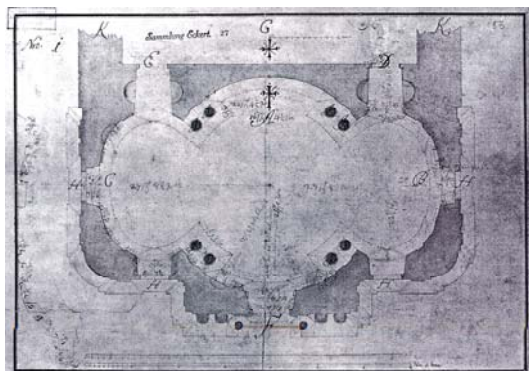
Schönbornkapelle, Grundriss
